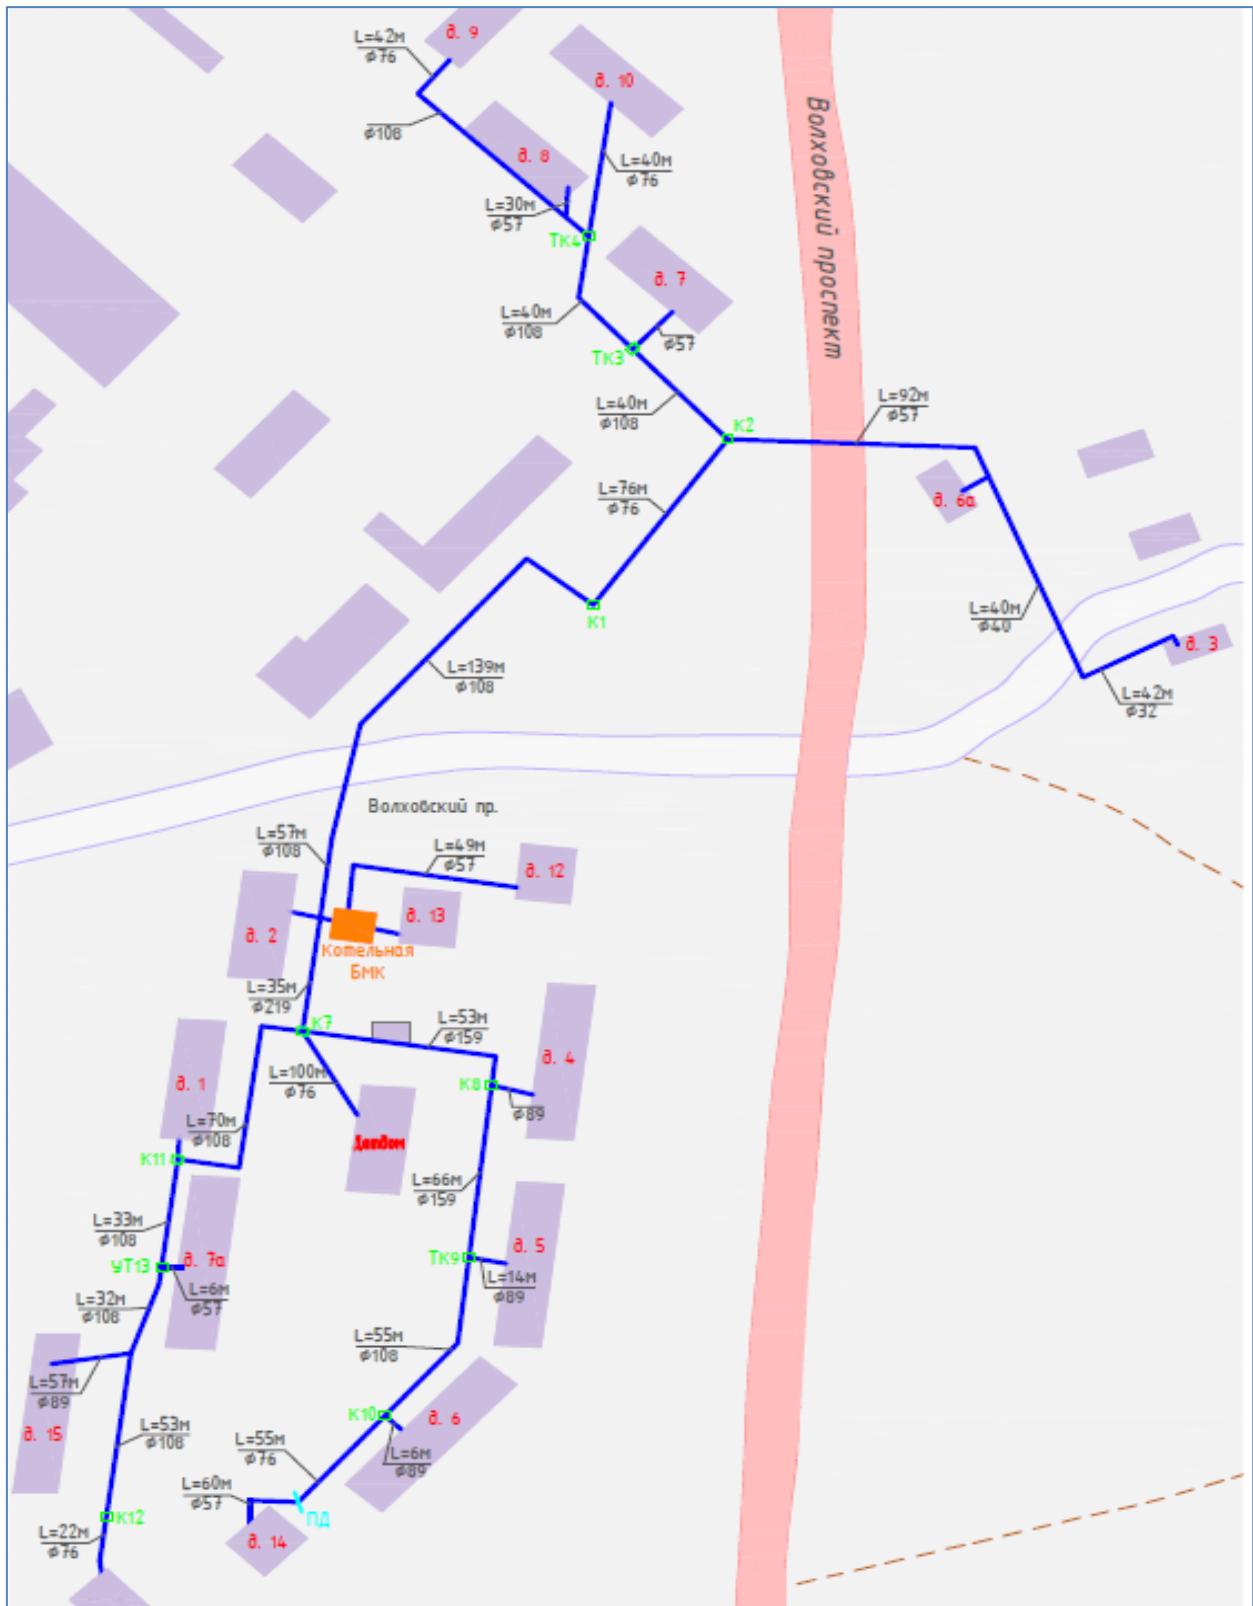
Схема тепловых сетей от котельной № 17.
